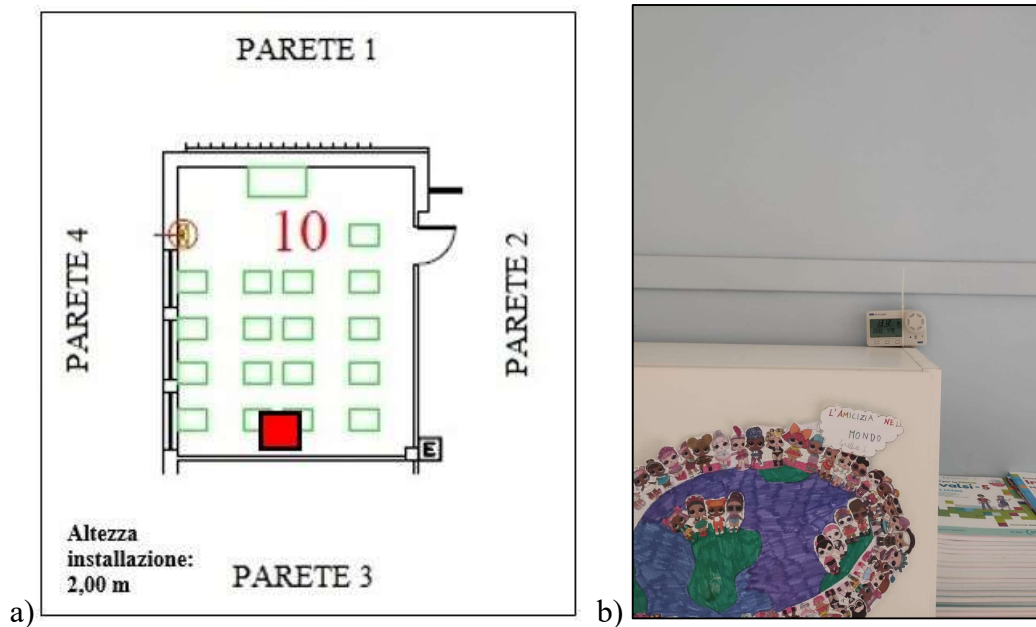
Posizione acquisitore in pianta (a) e in foto (b) Aula 10 (5°B)
